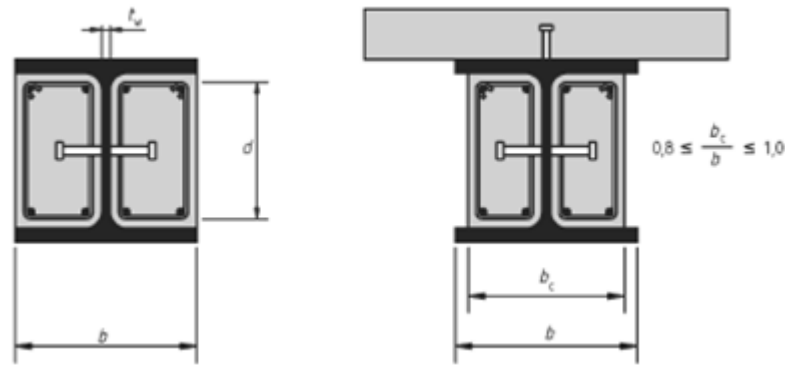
Secciones transversales típicas de vigas parcialmente embebidas
